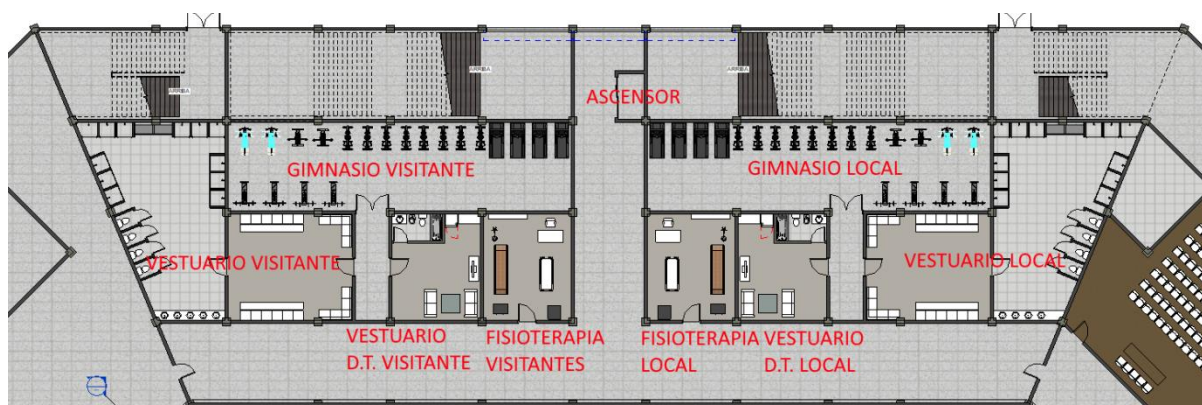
Vista en planta del sector norte de la planta baja, donde se encuentra el ala de deportistas. Fuente: elaboración propia.
